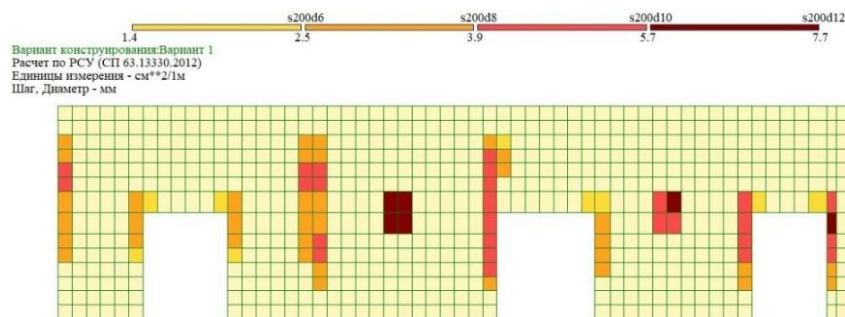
Подбор верхней продольной арматуры плиты
